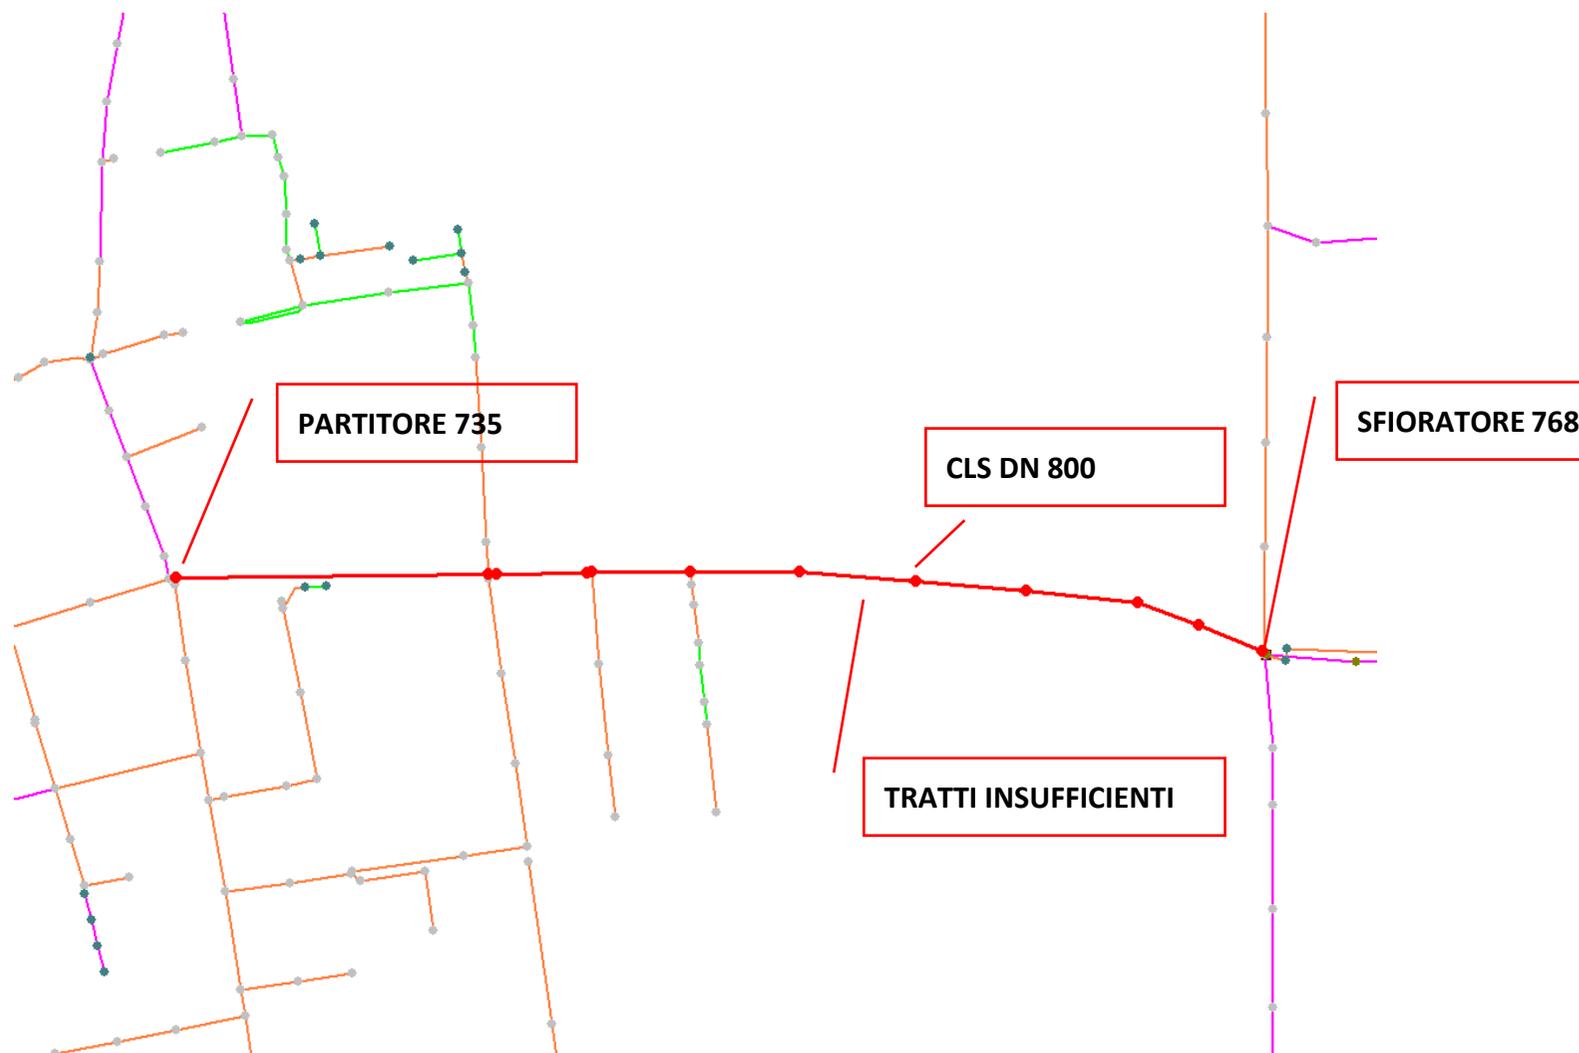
rappresentazione planimetrica del tratto di rete fognaria
